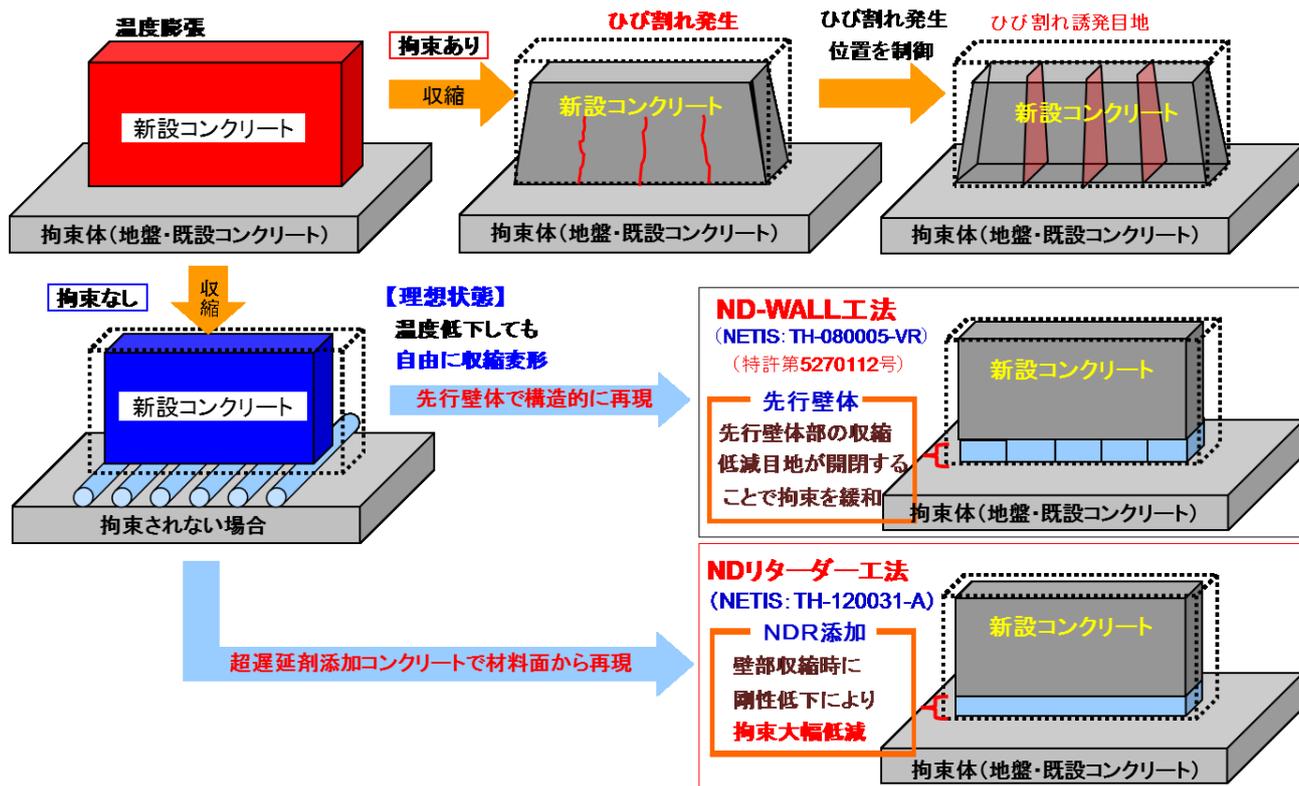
温度ひび割れの抑制メカニズム (ND-WALL工法とNDリターダー工法)
